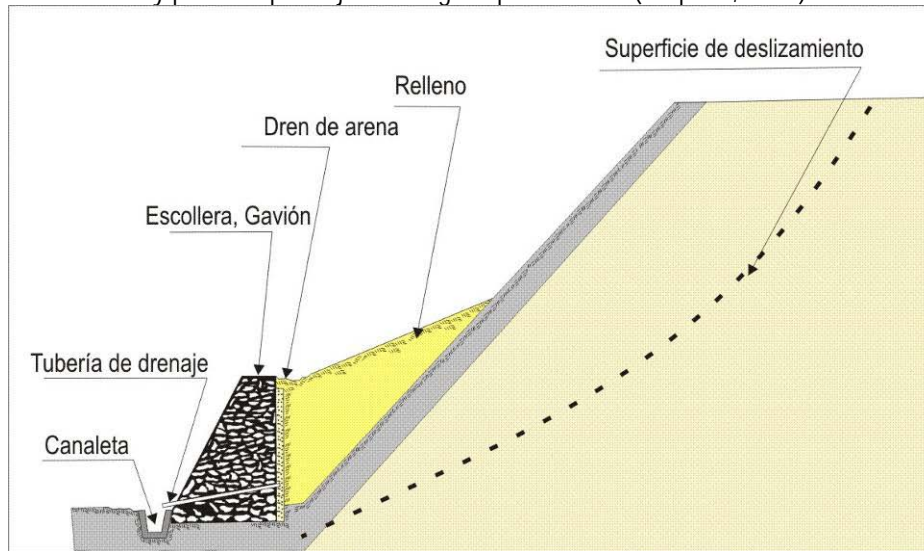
Muro permeable al pie del talud de una zona con deslizamiento.
